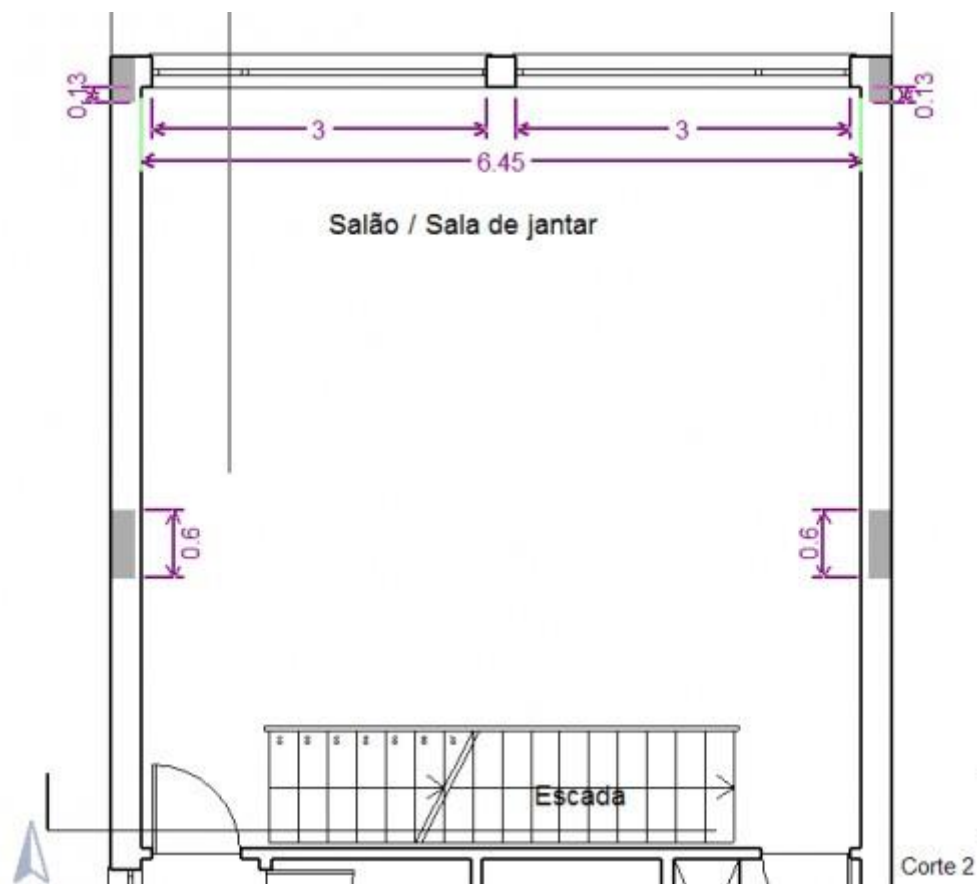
Levantamento dimensional das PTP de pilares do compartimento Salão em planta
